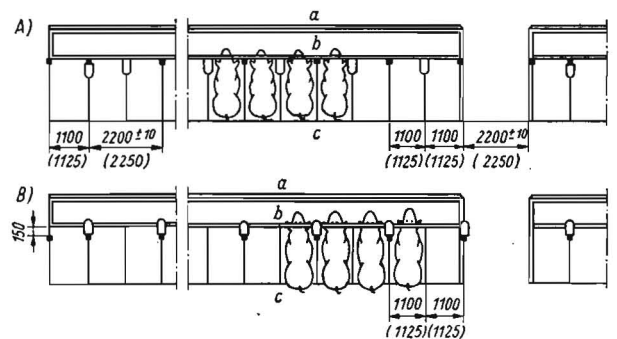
Grundrißrahmen der Stützenstellung bei Mittel- (A) und Kurzständen (B); a Futtergang, b Krippe, c Kotgang
